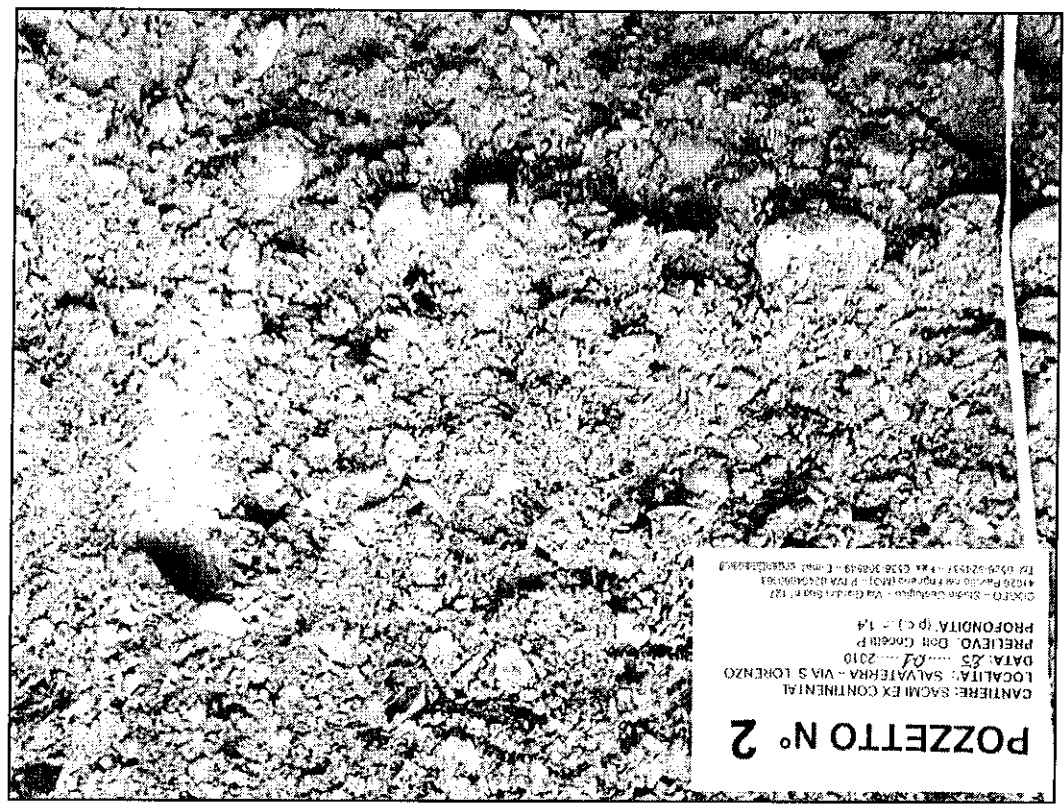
Pozzetto n° 2. Profondità -1.4 m dal p.c.
